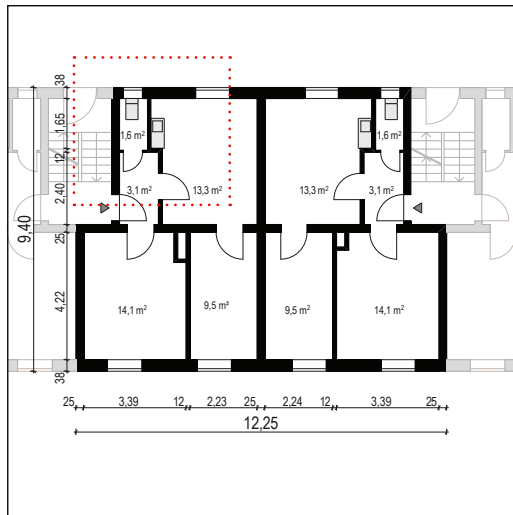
Beispielgrundriss Regensburg, Kriemhildstraße 15–17
